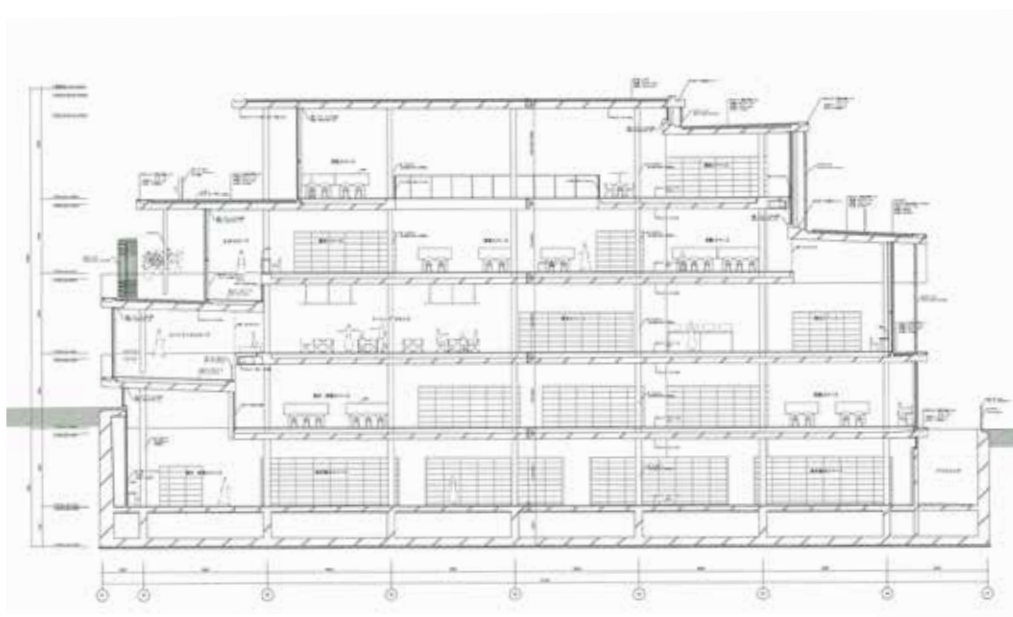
Corte transversal construtivo. "Sección transversal constructiva".
